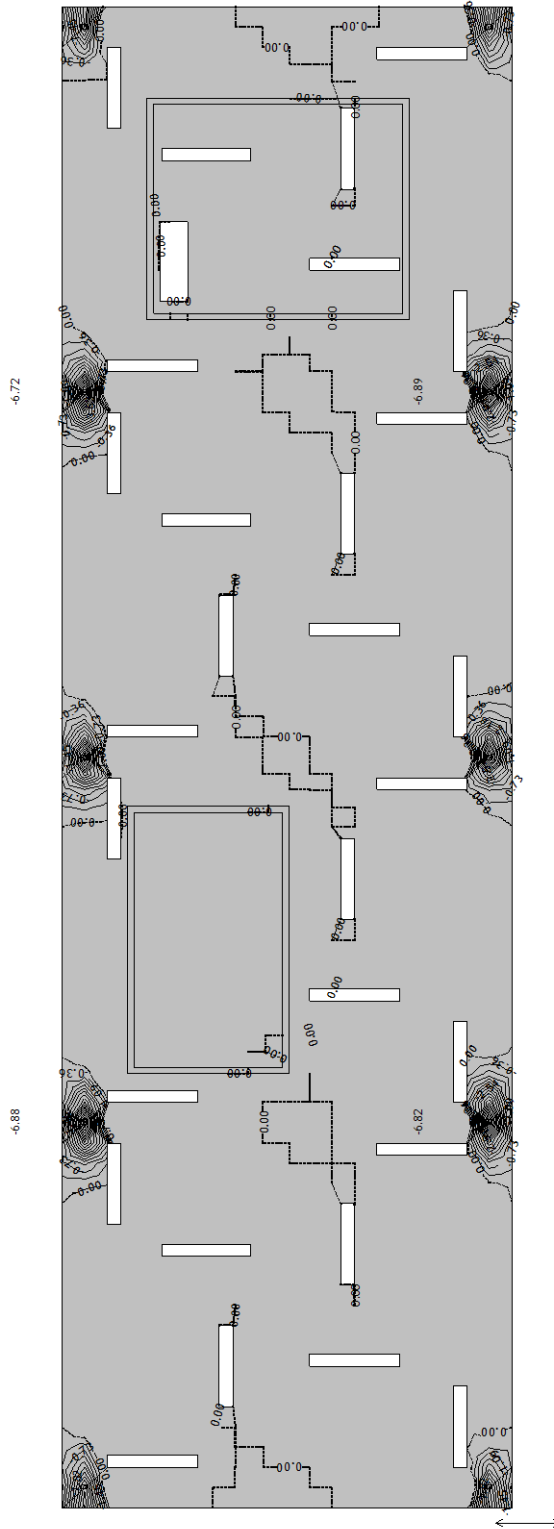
Erforderliche obere Bewehrung in X-Richtung – Dachplatte
